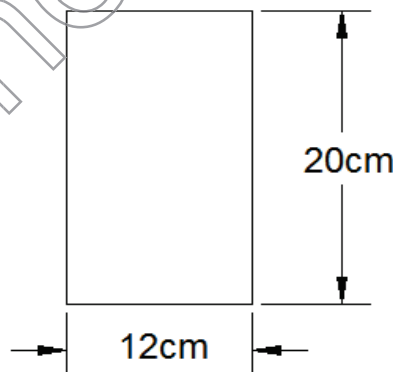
Coupe schématique de la poutrelle (appuis)
